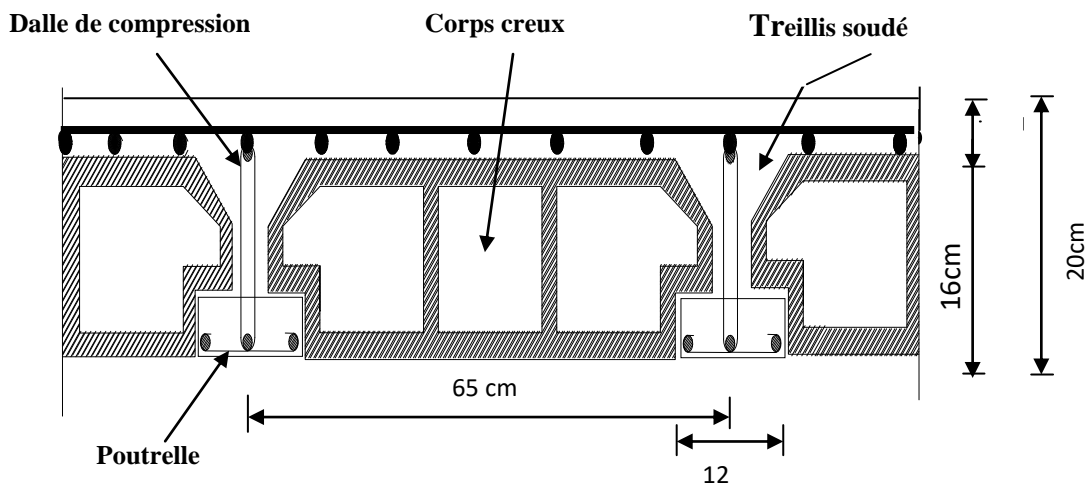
Schéma descriptif d'un plancher en corps creux.
